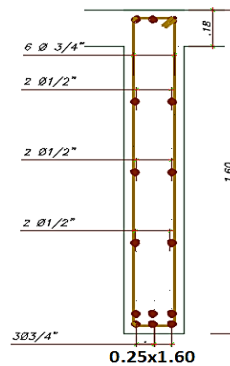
distribución de aceros de viga diafragma adaptado de los planos 114-87/4-11 Se presenta el metrado de acero de flexión de la viga diafragma.
